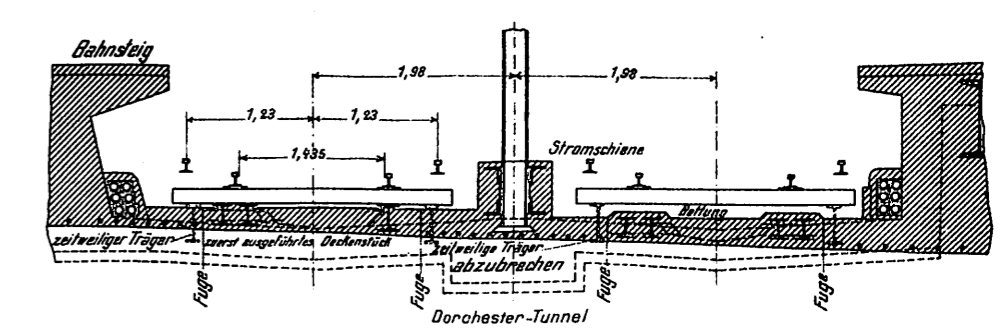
bis 7. Unterfahren des Tunnels in der Washington-Straße durch den Tunnel der Schnellbahn nach Dorchester. Abb. 5. Grundriß. Maßstab 1:150.
